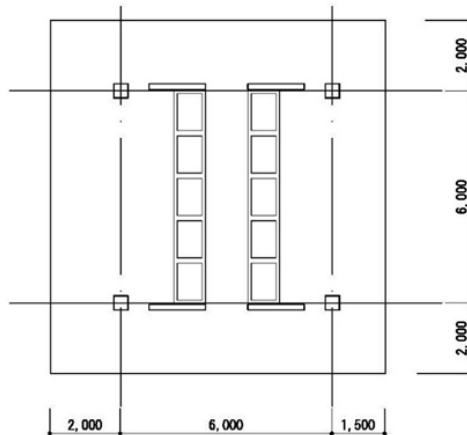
Plan de l'espace de vente au détail du poisson
